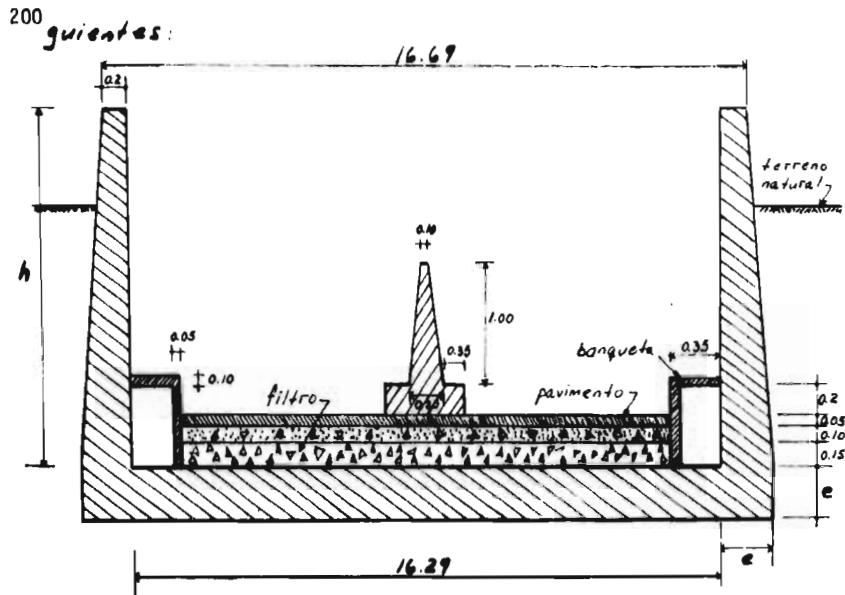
SECCION TRANSVERSAL EN ZONA DE MUROS DE RETENCION CON LOSA CORRIDA.
